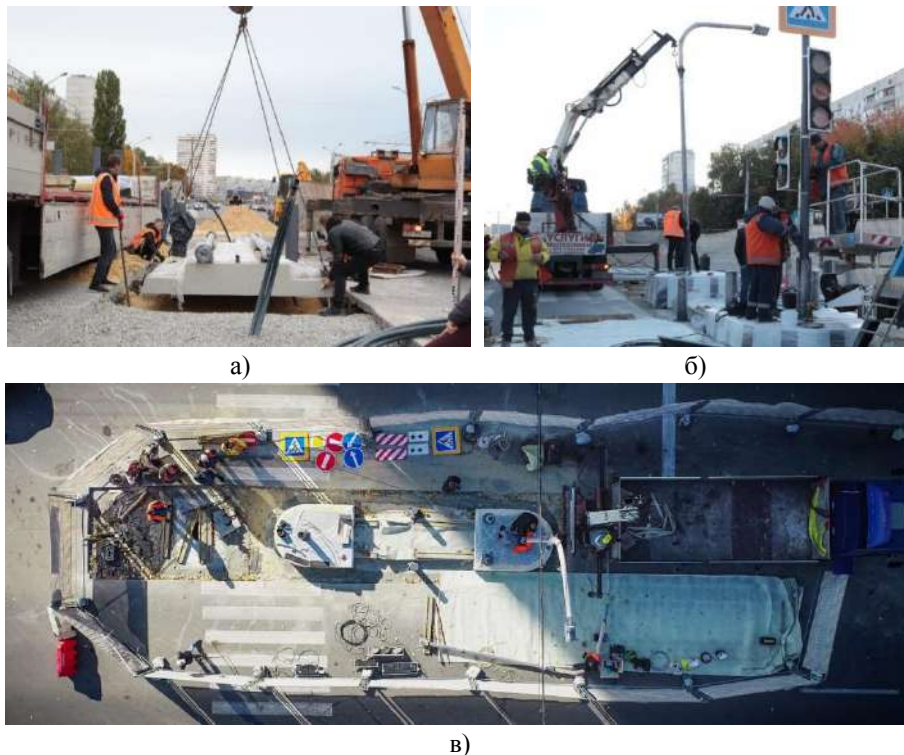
Поетапний монтаж СБП: а) монтаж пішохідної плити; б) монтаж рефюджів; в) монтаж світлофорних стійок
